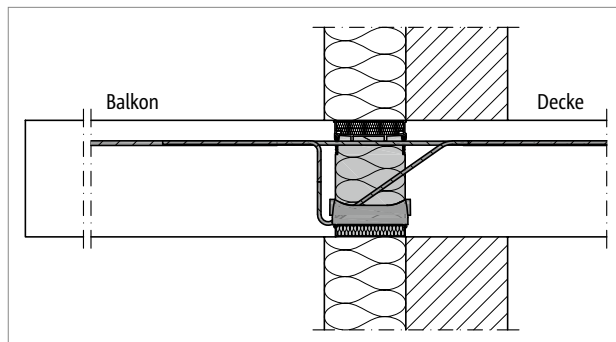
Schöck Isokorb® XT Typ K: Anschluss bei Wärmedämmverbundsystem (WDVS)
